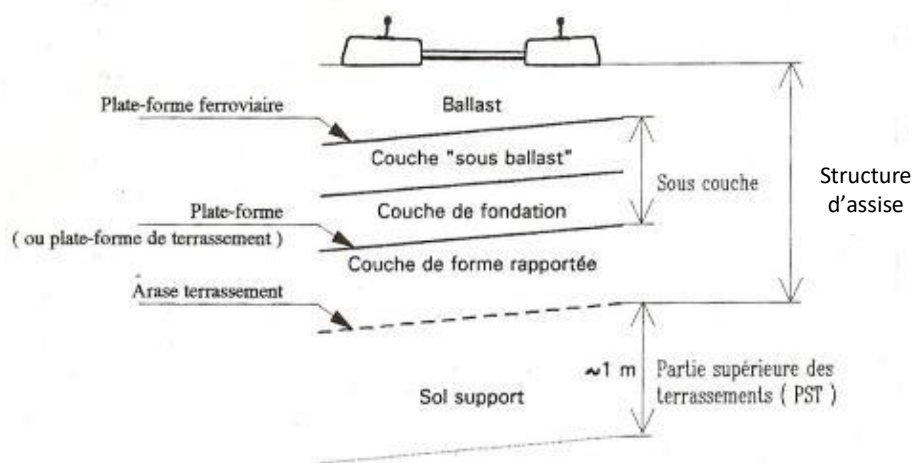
Différentes couches d'assises d'une plateforme ferroviaire [20]
